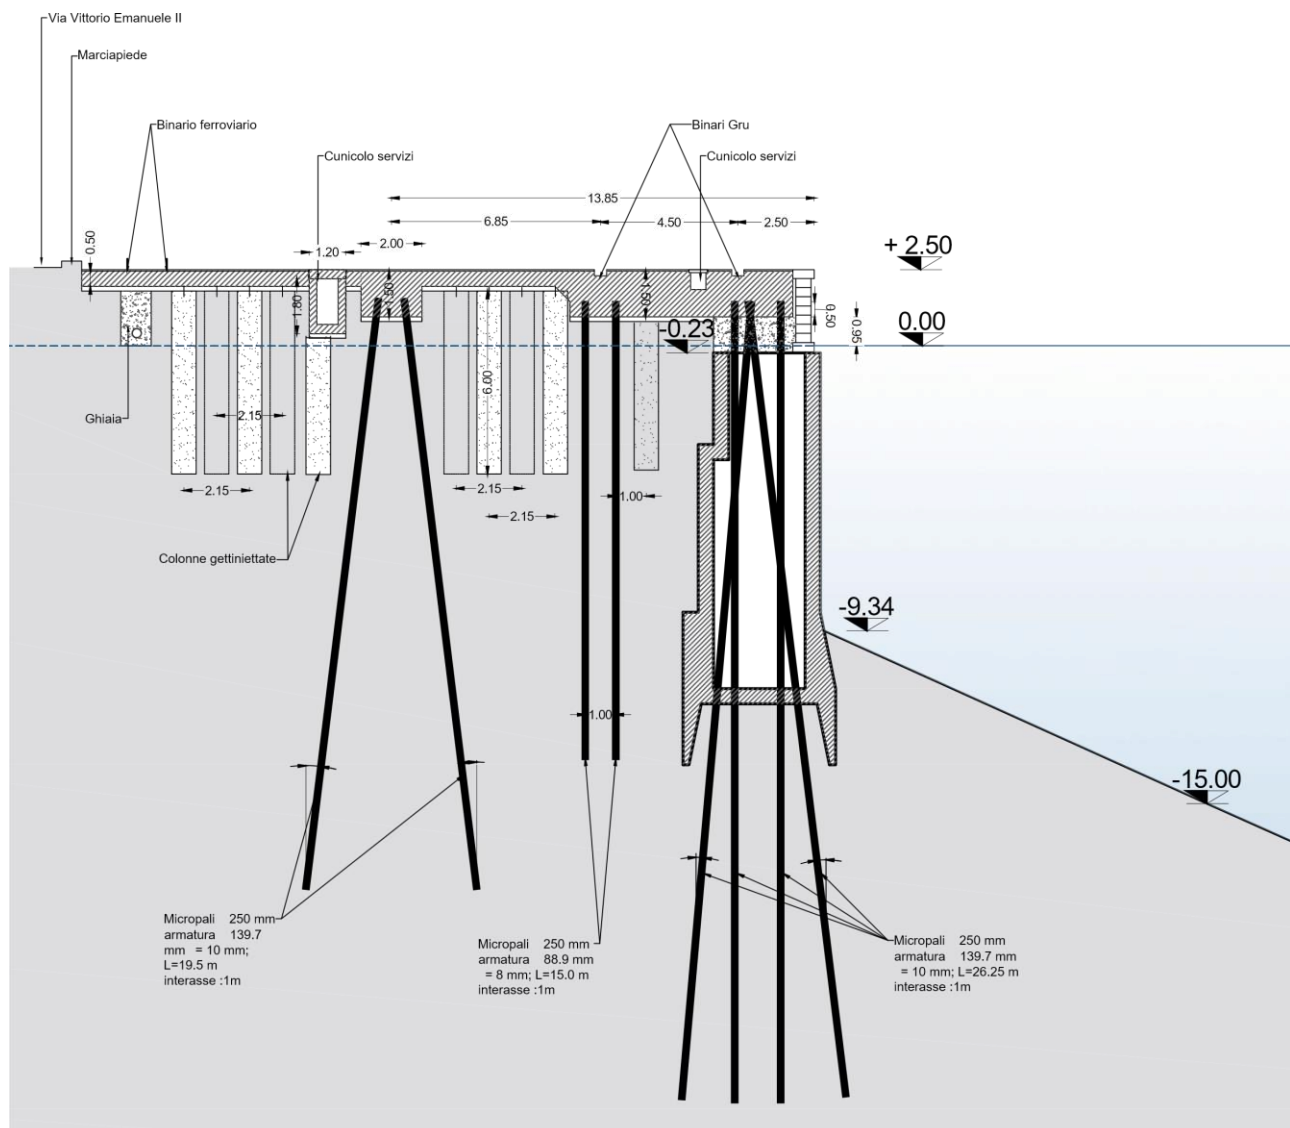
Banchina Peloro – Sezione tipo stato attuale
